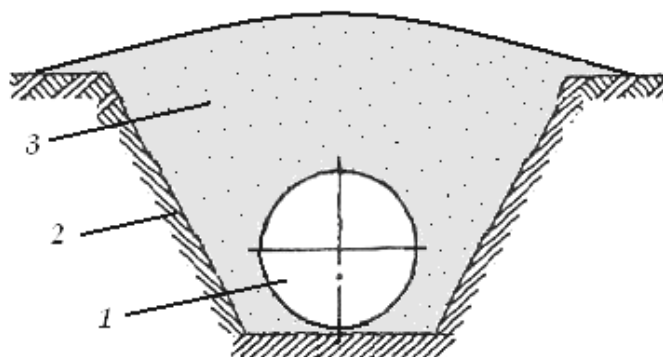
Схема подземной прокладки газонефтепроводов: 1 – трубопровод; 2 – профиль траншеи; 3 – грунт обратной засыпки
